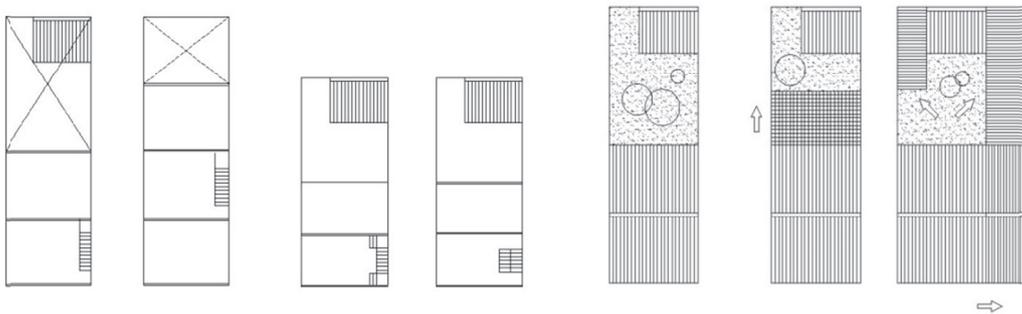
Esquemas de vivienda con patio posterior y escalera en primera o segunda crujías.
